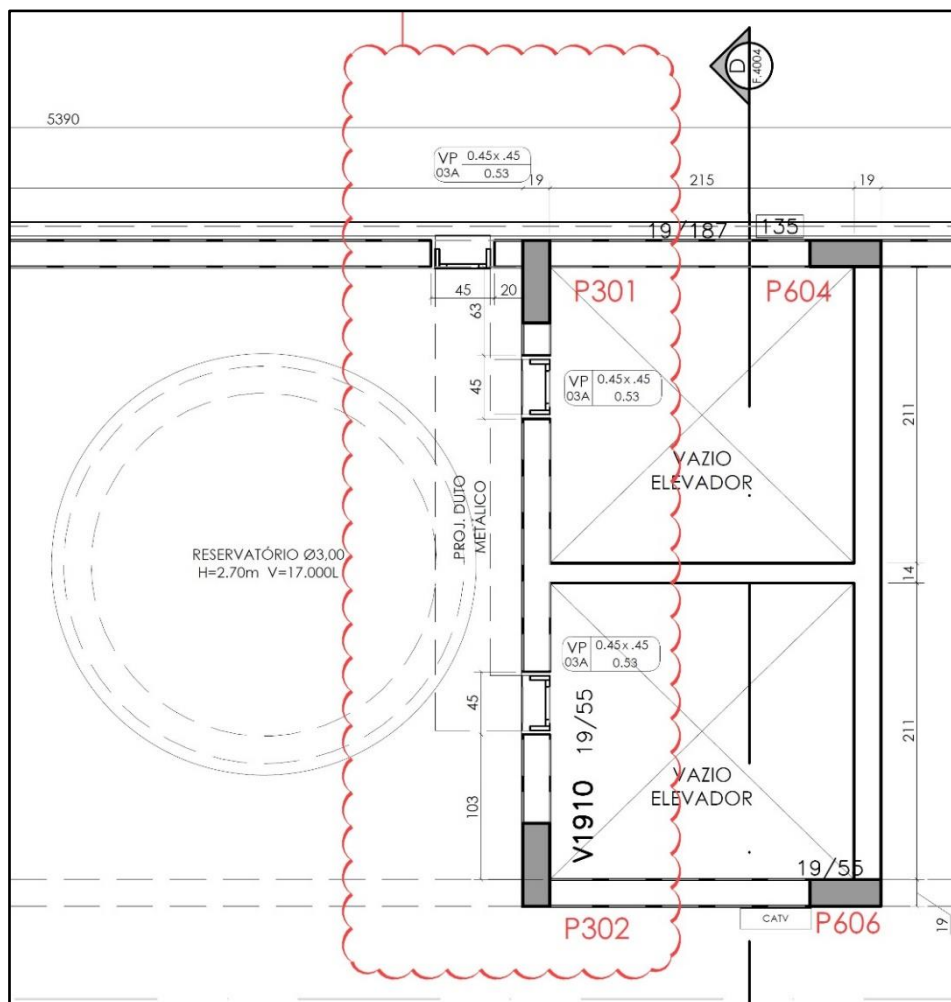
Planta baixa do barrilete - caso 2 (fonte: empreendimento estudo de caso)
